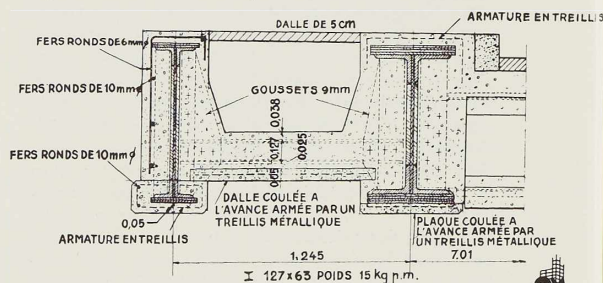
Détail des poutres principales et du caniveau du pont de la figure 359.
